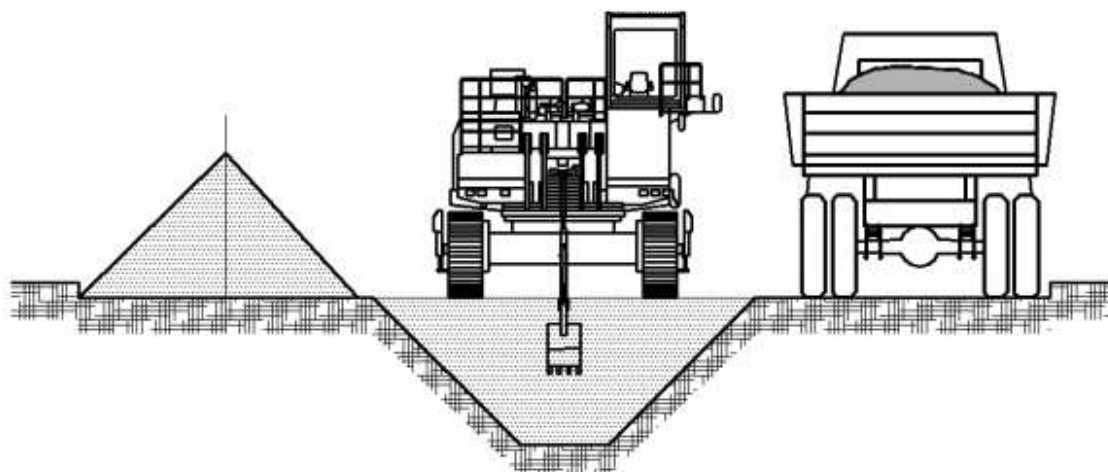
Схема разработки грунта в траншее экскаватором
